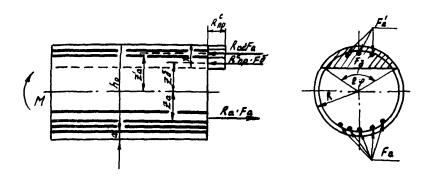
Рис. IO. Схема расположения усилий и эпира напряжений в поперечном сечении изгибаемого элемента с двойной арматурой.
